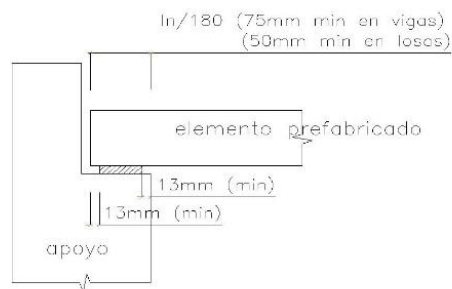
Longitud de apoyo de un elemento prefabricado.
